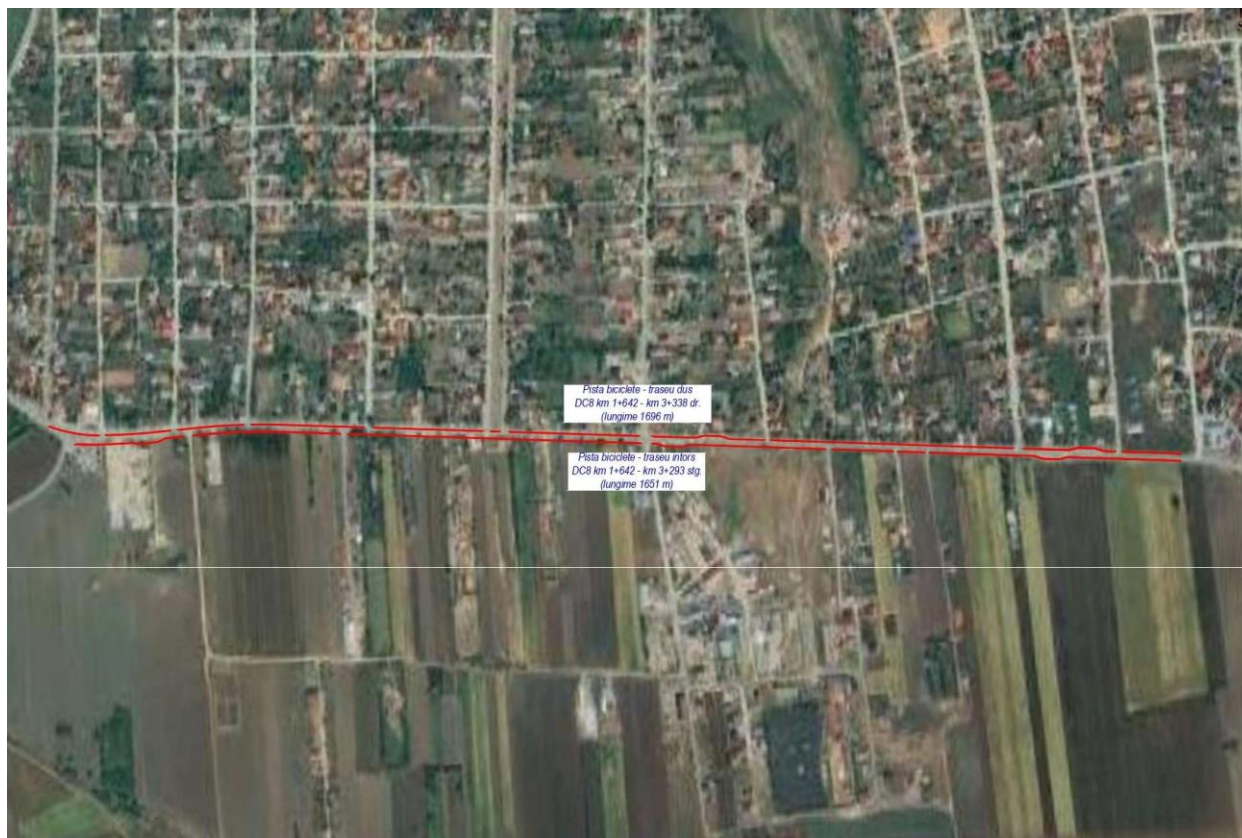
Plan de incadrare in zona teren studiat (conf. plan intocmit de proiectant)
